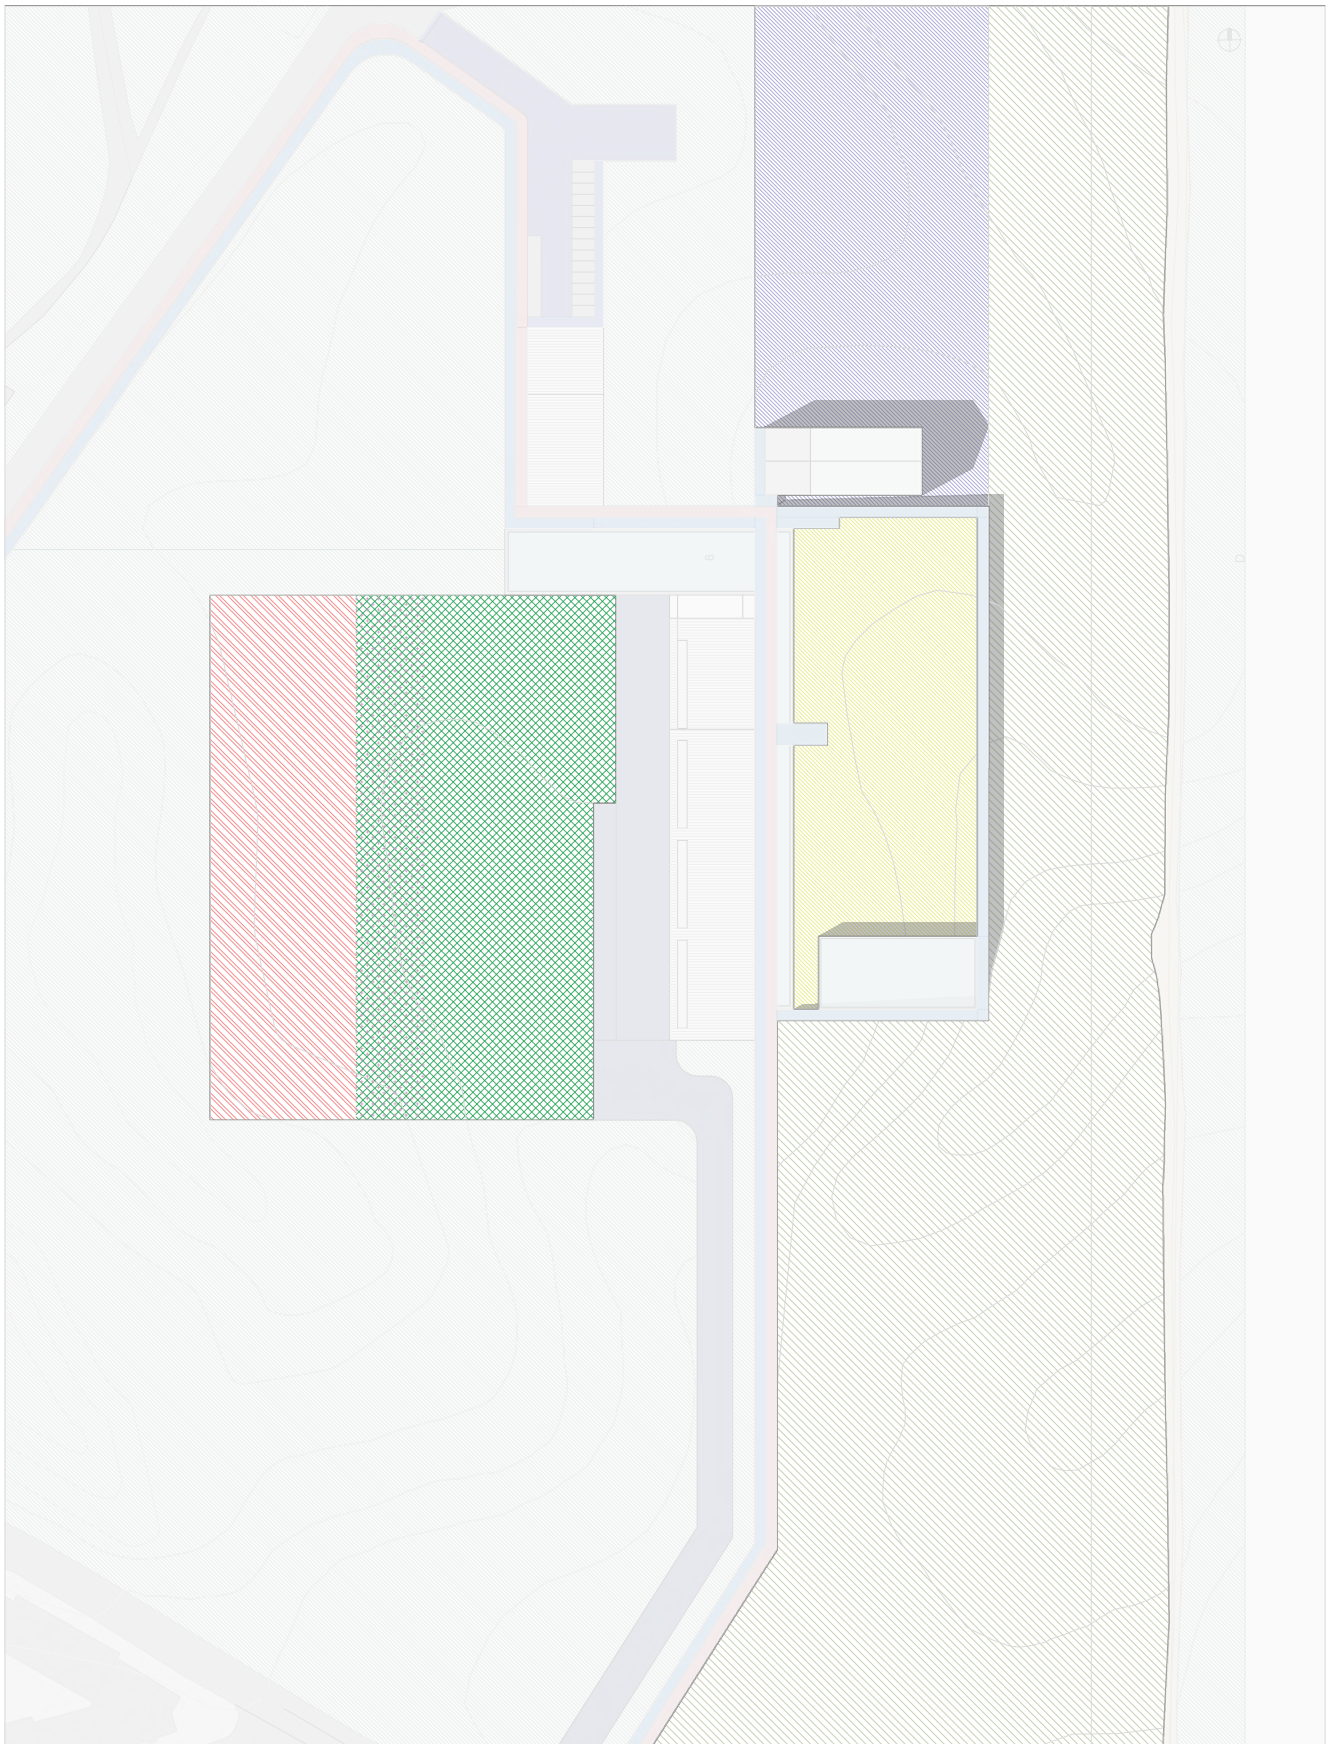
Planta da Proposta de Intervenção com a indicação das áreas plantadas, sem escala.
